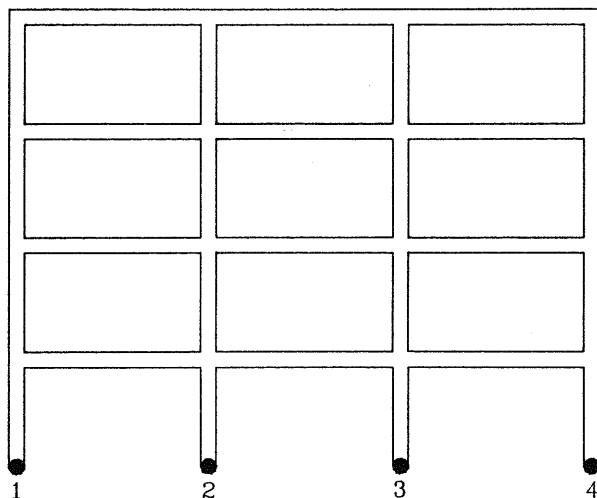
Macroelemento che rappresenta un telaio piano da connettere alla trave di fondazione
